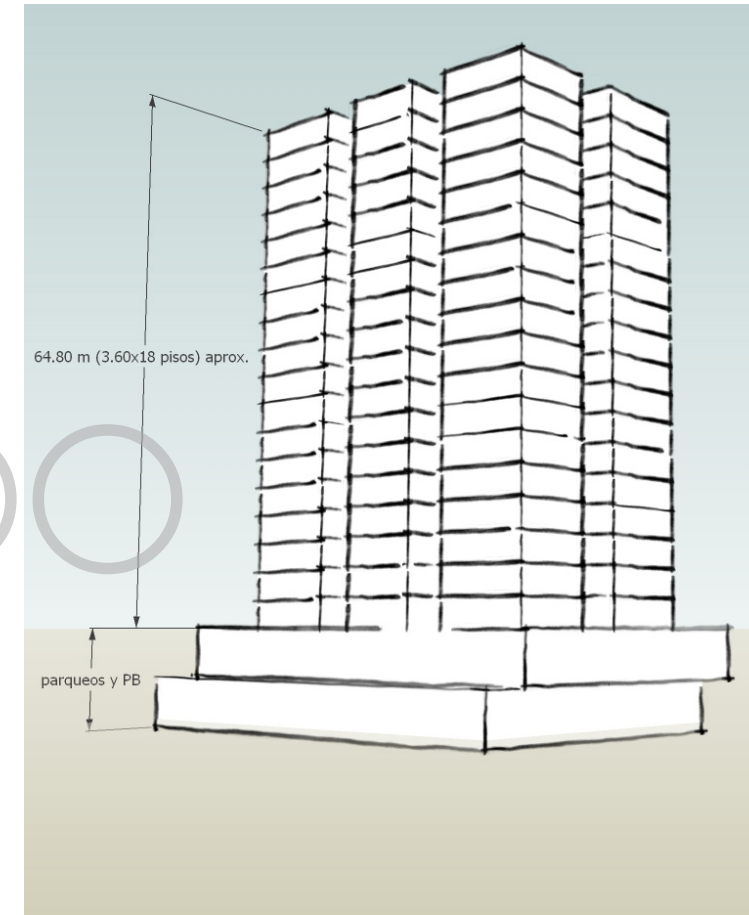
Esquema de pisos de departamentos en edificio en alturaFuente: Realizado por Denisse Aguilera
